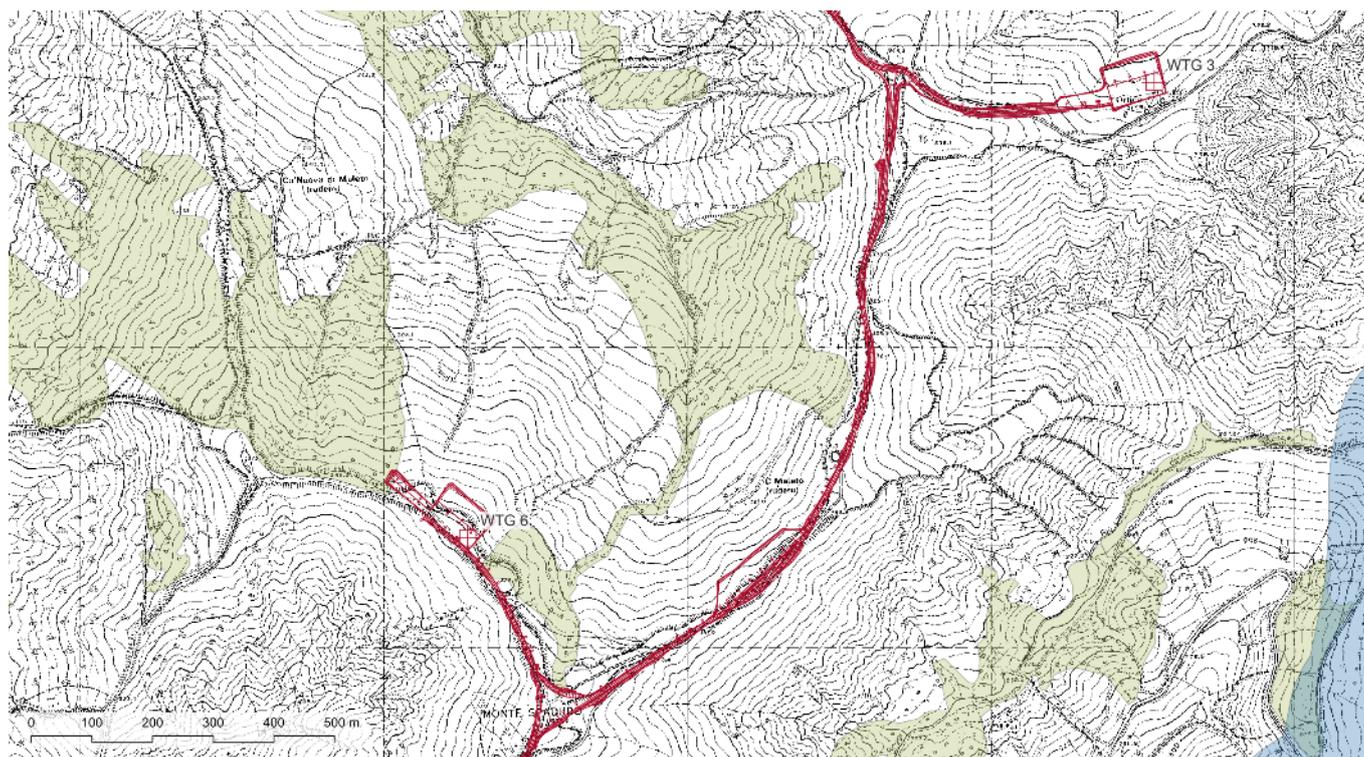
Stralcio planimetrico dei vincoli ex Art.142 individuati dalla Regione Emilia Romagna in relazione ai WTG 3 e 6 e tratti di viabilità di connessione interessati dalle opere di adeguamento e nuova costruzione
